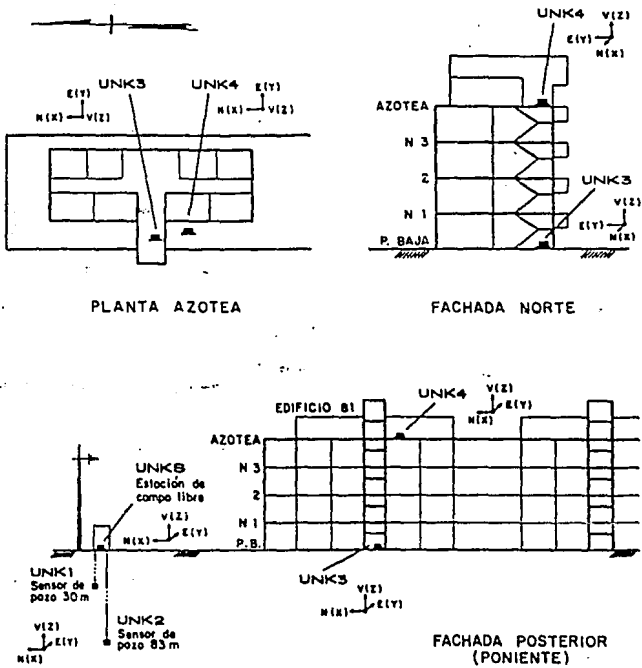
niveles, con losas de concreto, en zona de lago (ref 1).
